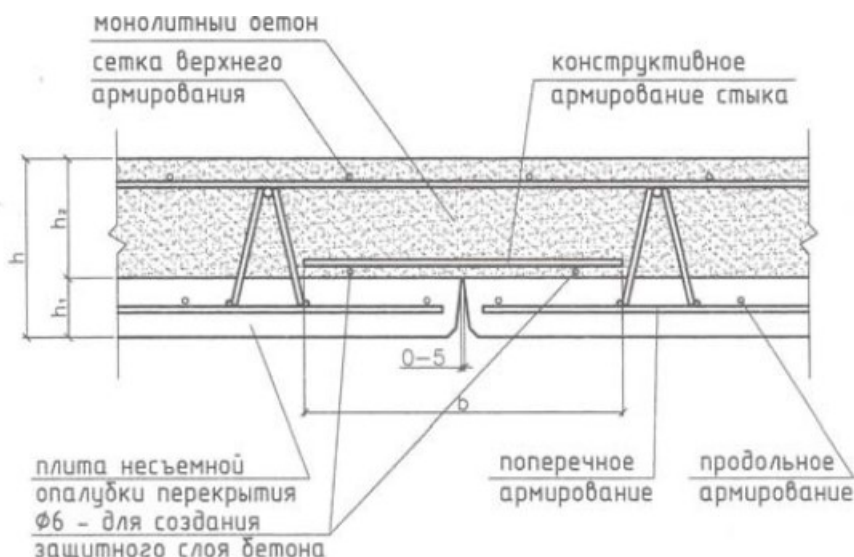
Сборно-монолитная плита перекрытия Filigran
